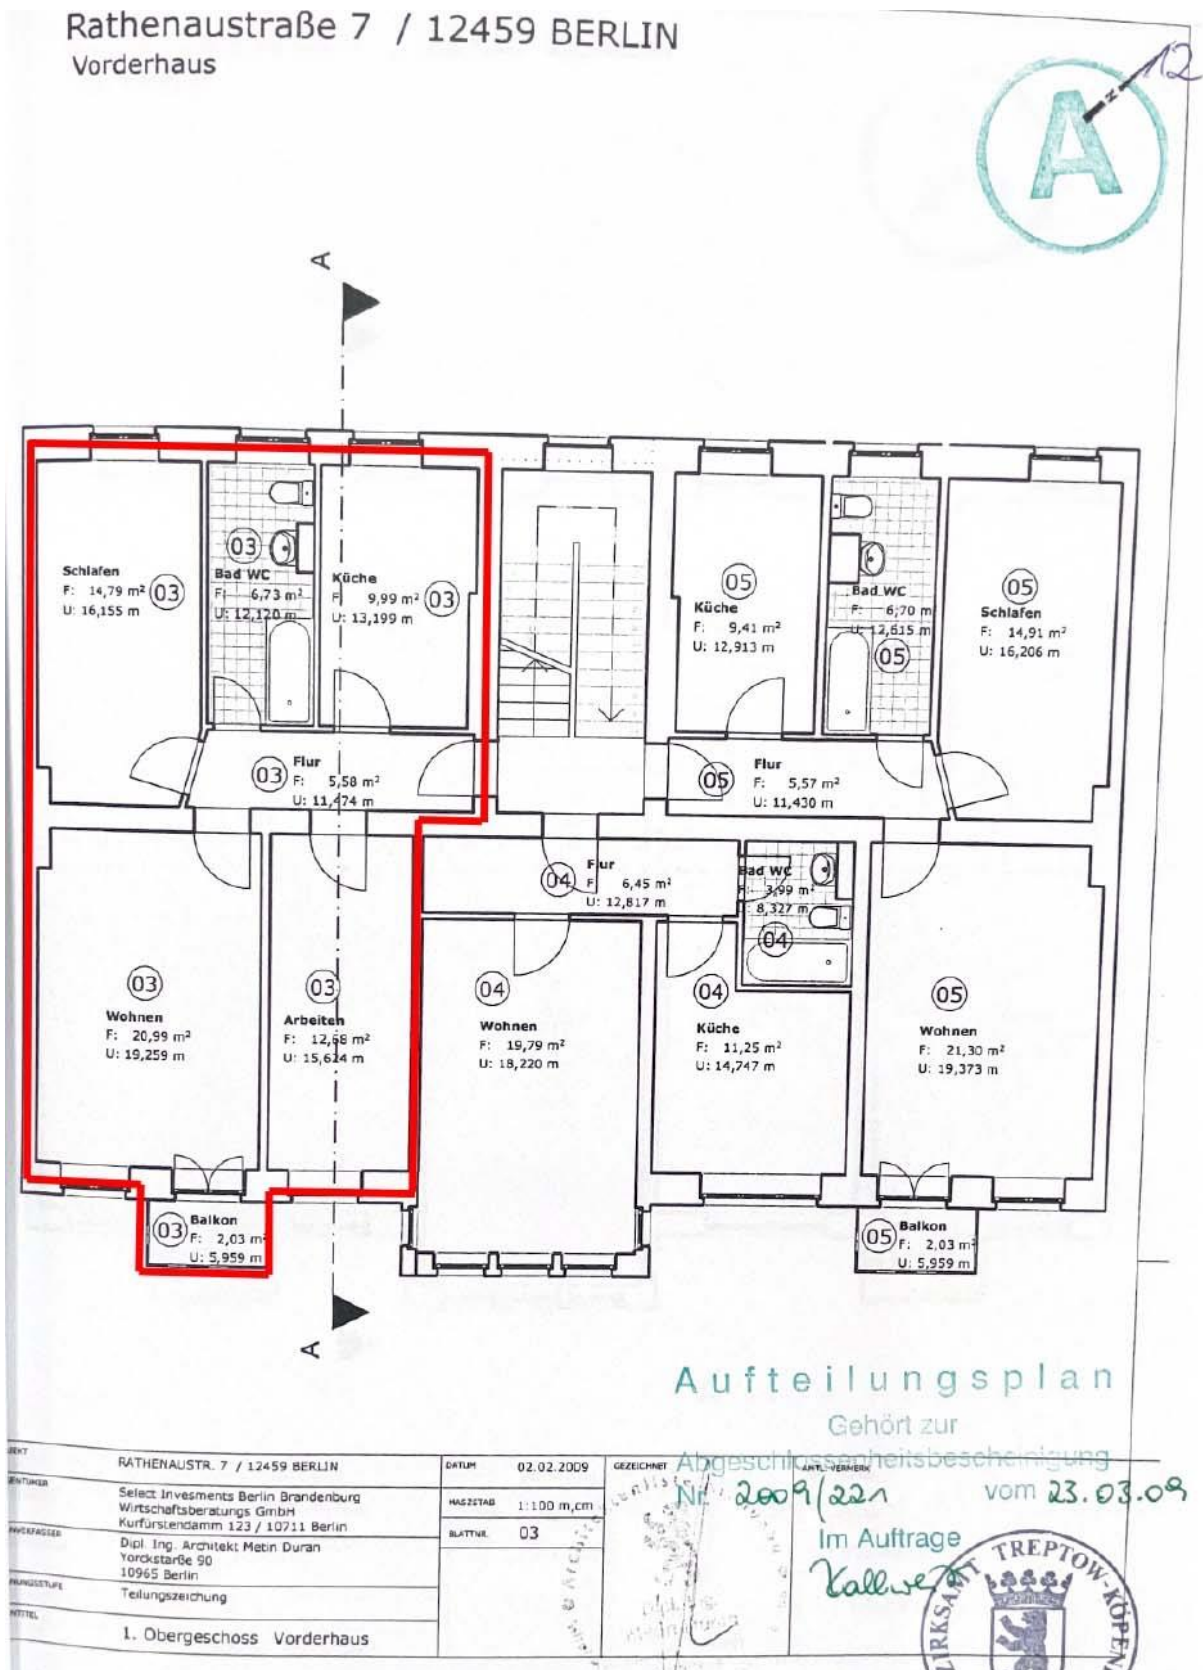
Grundriss 1. OG Vorderhaus mit Wohnung Nr. 3
